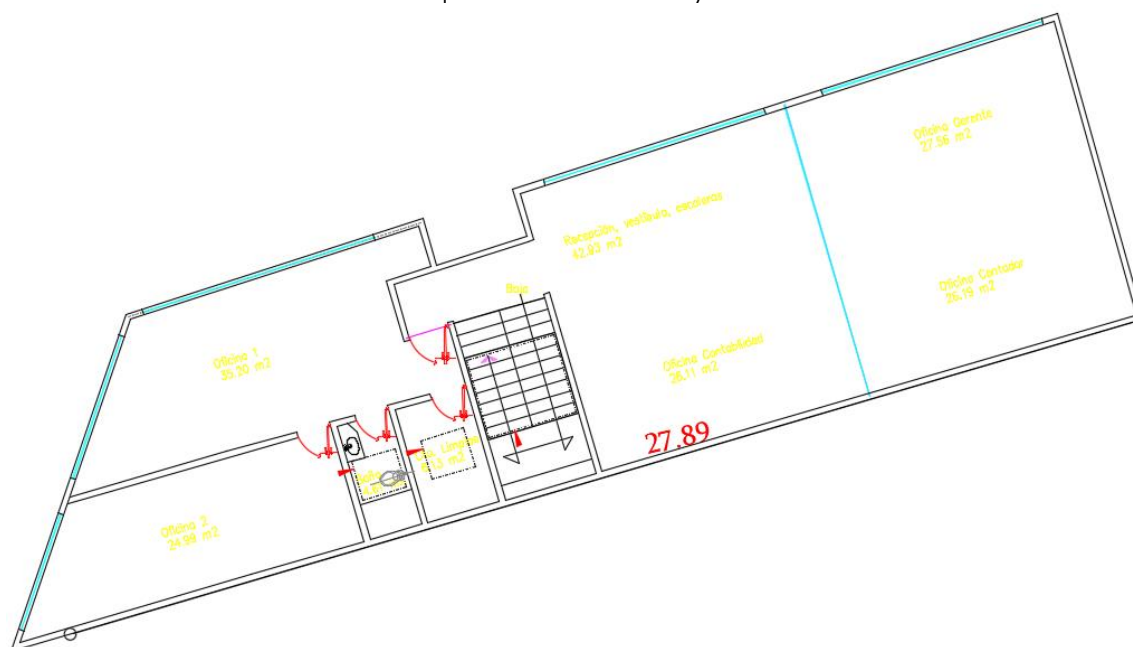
Extractos del Plano Arquitectónico del Proyecto
